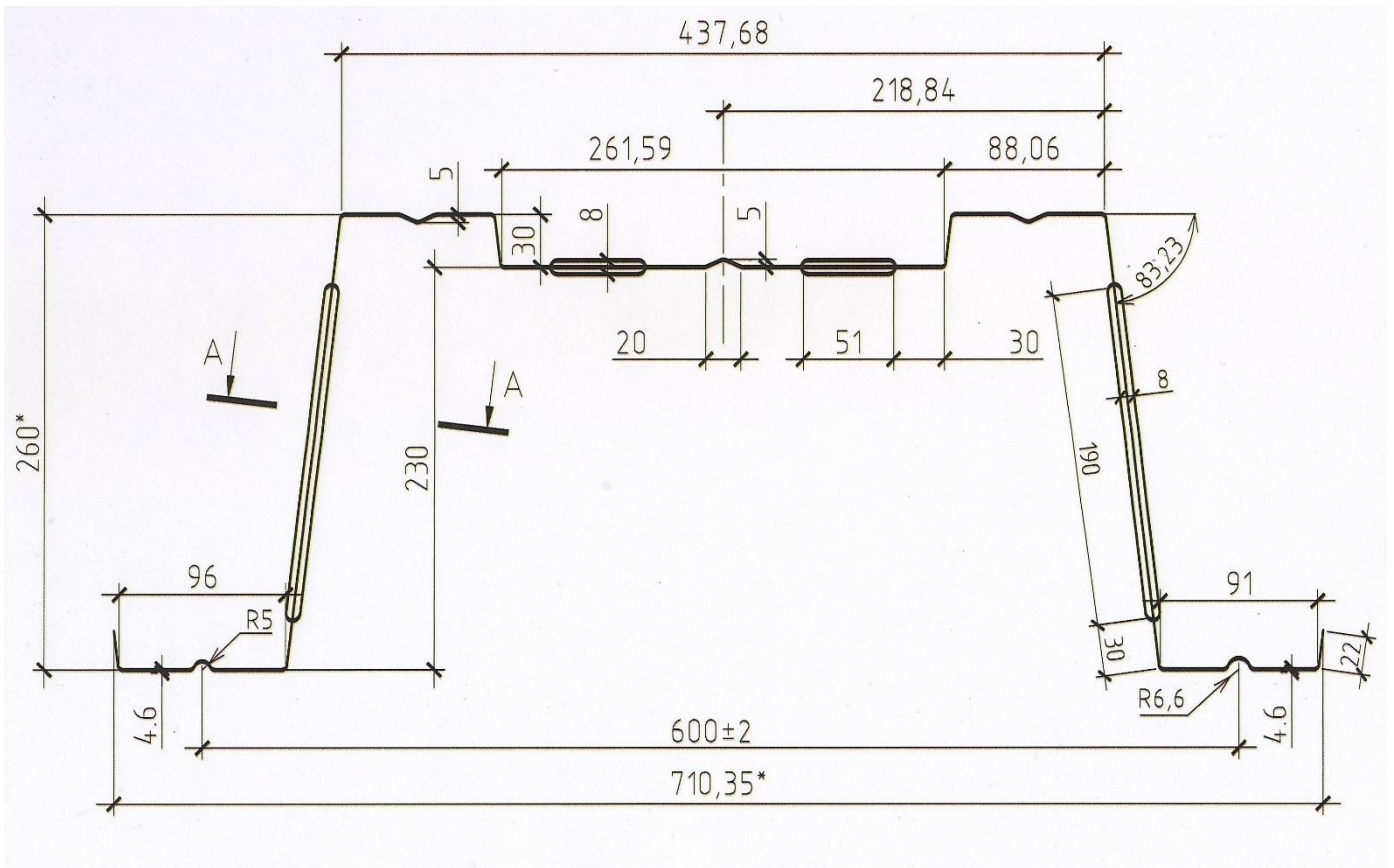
Схема расположения гофров профиля, размеры профиля ППУ «БИЗОН» 1,0/260/600
